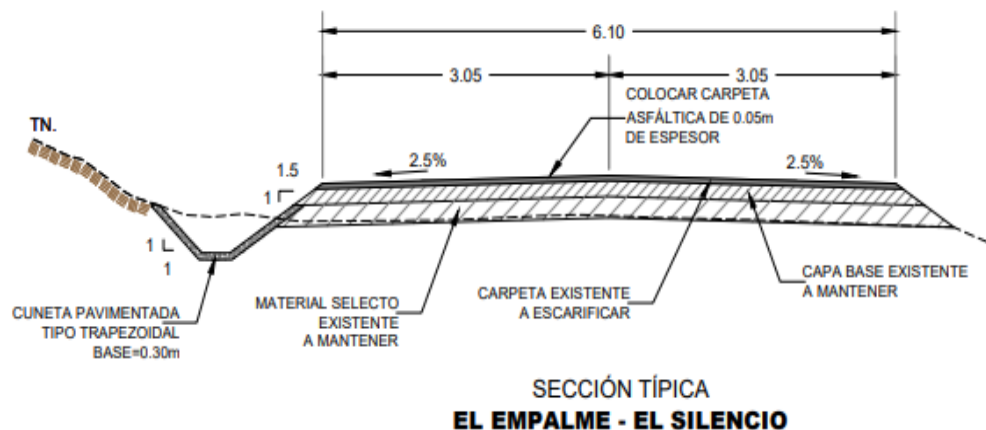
Sección típica El Empalme-El Silencio. Fuente: Planos del proyecto
